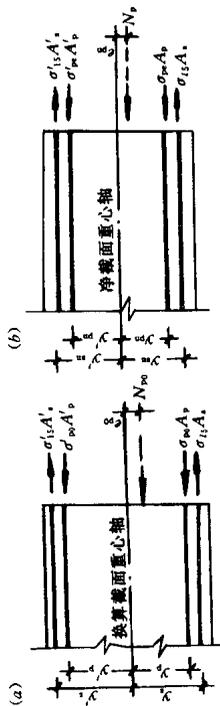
预应力钢筋及非预应力钢筋合力位置
